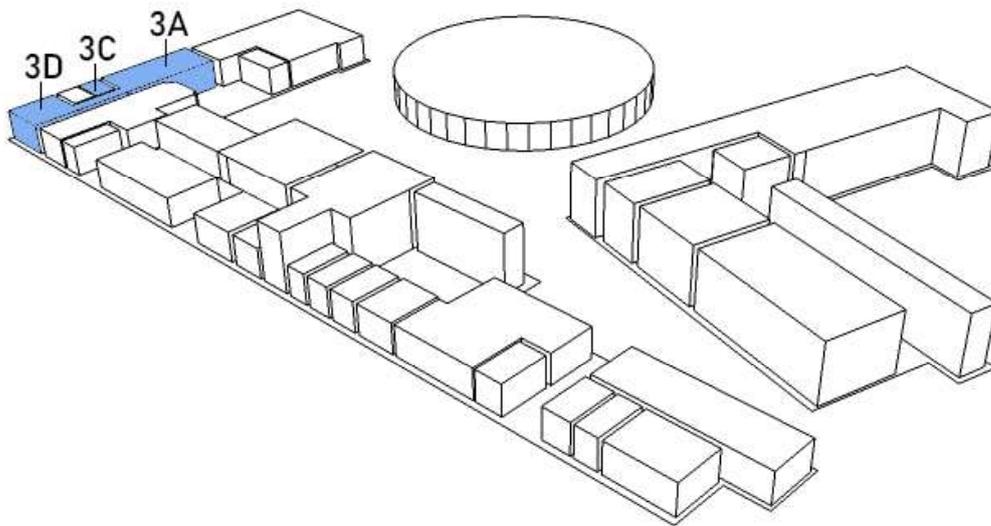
Schema tridimensionale con individuazione dei locali dedicati al laboratorio di modellistica, piano terra
